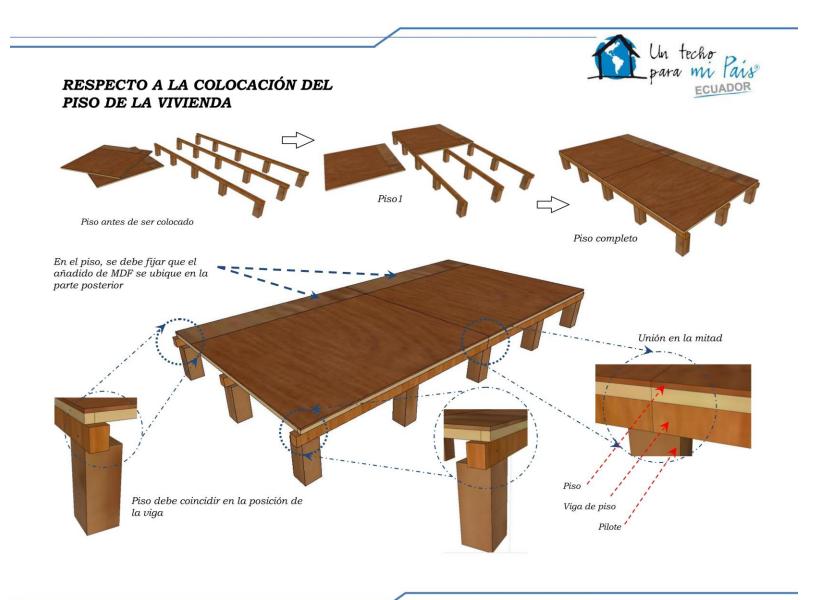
Colocación de piso, Fuente: Manual para la construcción - TECHO
